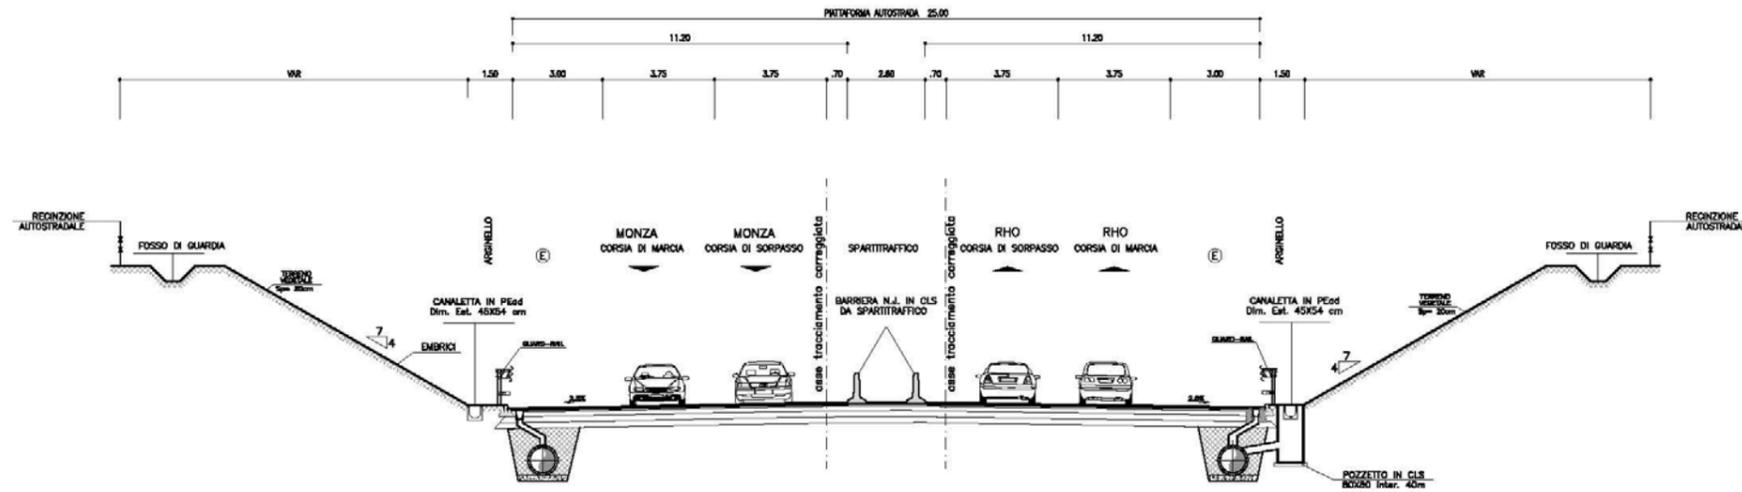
Tracciato in trincea – Sezione in Rettifilo
